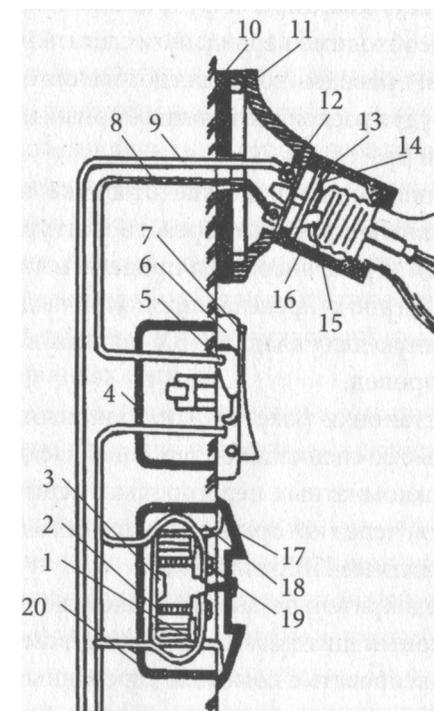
Установочная аппаратура: 1 — распорная лапка; 2 — корпус розетки; 3 — скоба-фиксатор; 4 — монтажная коробка; 5 — контакт выключателя; 6 — остов выключателя; 7 — клавиша выключателя; 8 — проводник (фаза); 9 — проводник («земля»); 10 — подрозетник; 11 — основание патрона; 12 — контакт патрона; 13 — вкладыш; 14 — Центральный пластинчатый контакт патрона; 15 — боковой пластинчатый контакт патрона; 16 — юбка патрона; 17 — крышка розетки; 18 — гнездо розетки; 19 — контакт розетки; 20 — монтажная коробка
